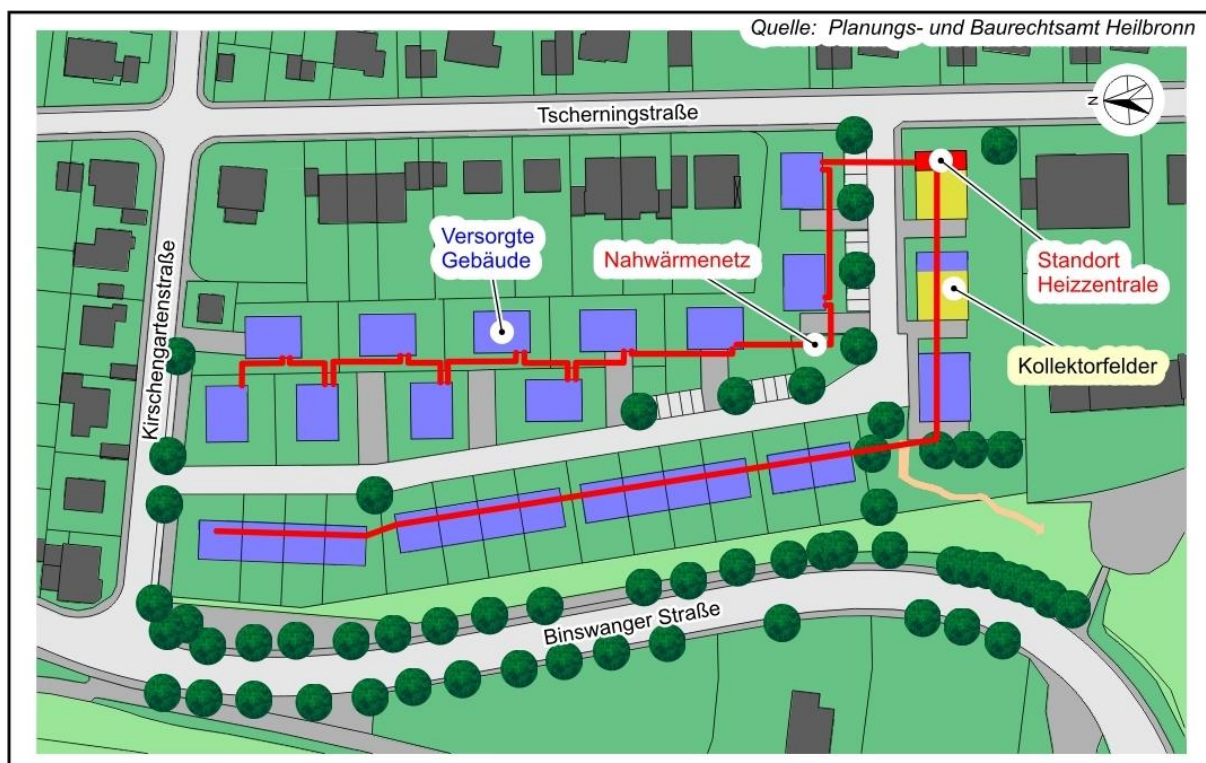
Lageplan Heilbronn, Neubaugebiet Kirschengartenstraße
